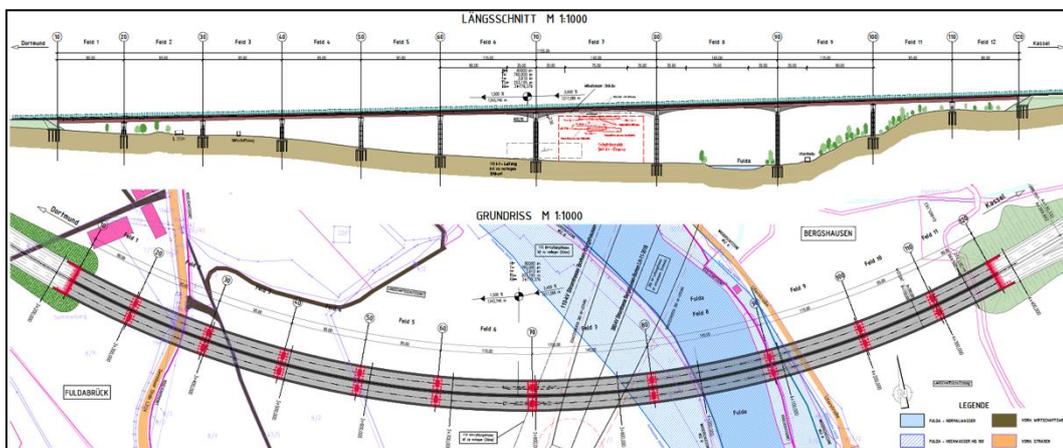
Längsschnitt und Grundriss der Variante 3
